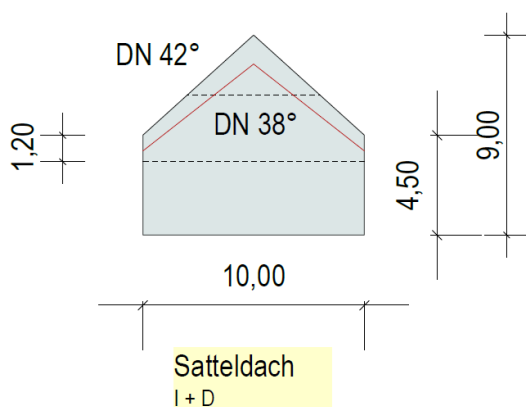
Mögliche Gebäudeausführung bei Haustyp I + D
